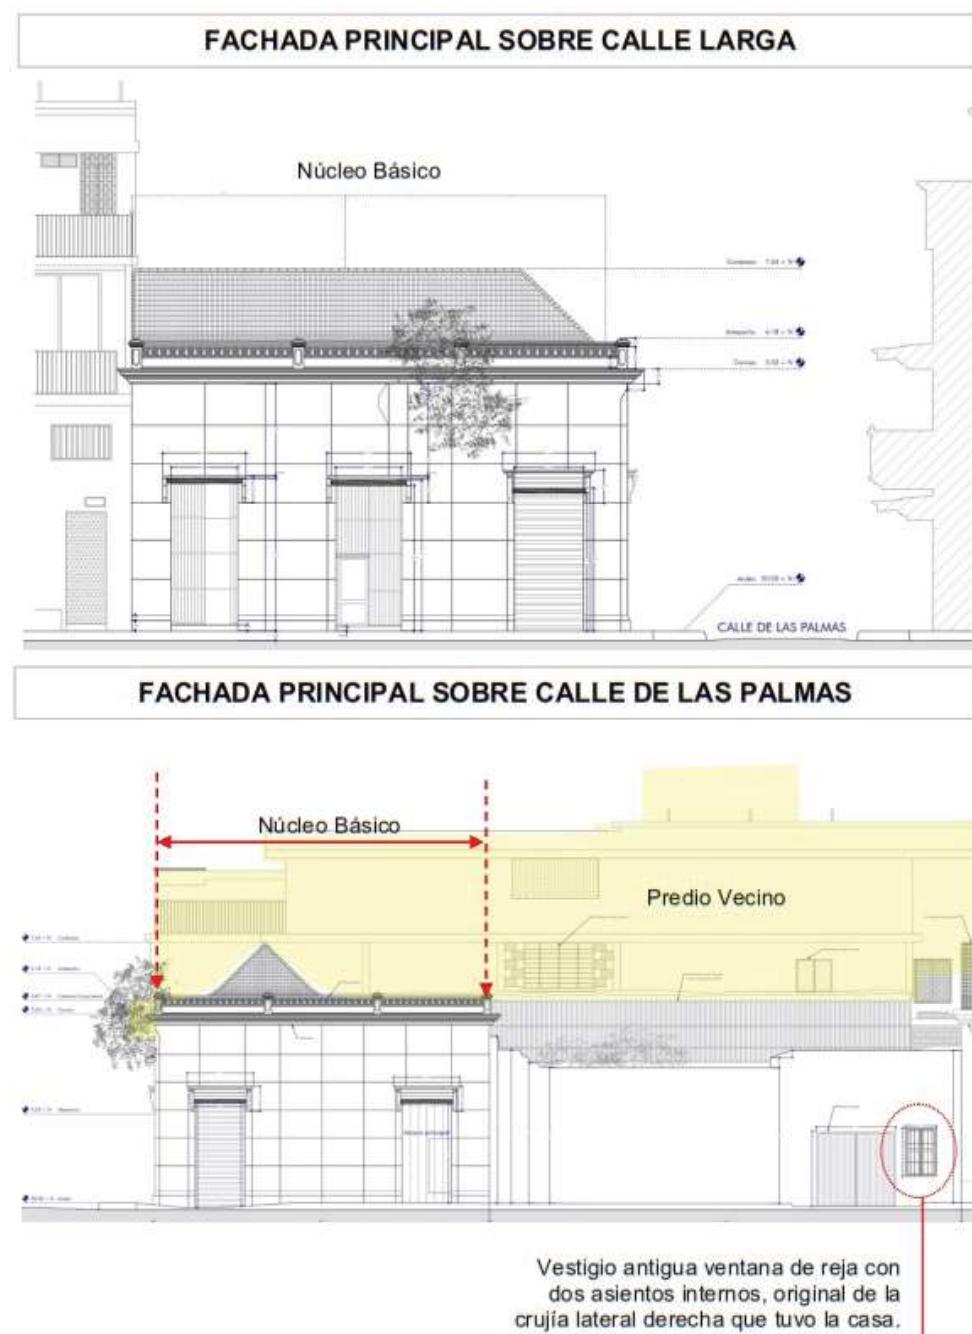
Levantamiento arquitectónico fachada principal sobre la calle Larga y Fachada lateral sobre Calle Las Palmas, casa “Landinez”. Fuente: Levantamiento arquitectónico. Elaboración propia y Andrés Felipe Mendoza.
